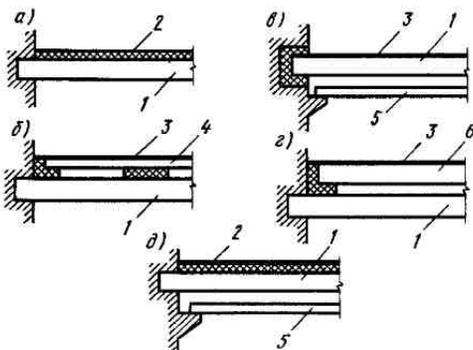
Конструктивные схемы перекрытий: а — со слоистым покрытием пола, б — с раздельным полом, в — с раздельным потолком, г — раздельное перекрытие из двух несущих панелей, д — с раздельным потолком и слоистым покрытием пола, 1 — несущая панель перекрытия, 2 — теплый звукоизолирующий слоистый пол, 3 — покрытие пола, 4 — панель основания раздельного пола, 5 — панель раздельного потолка, 6 — несущая панель пола
